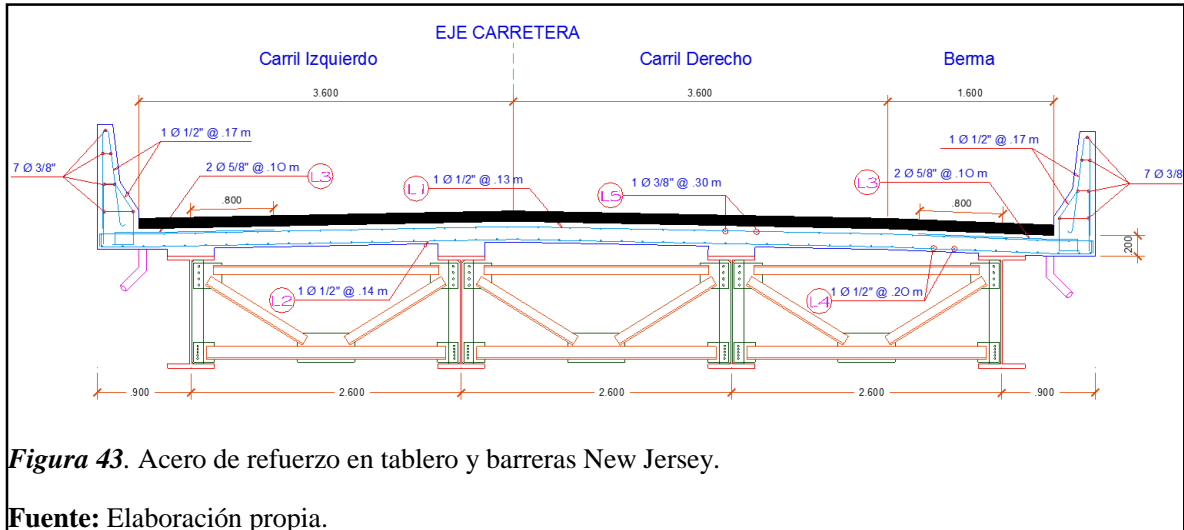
Acero de refuerzo en tablero y barreras New Jersey.
